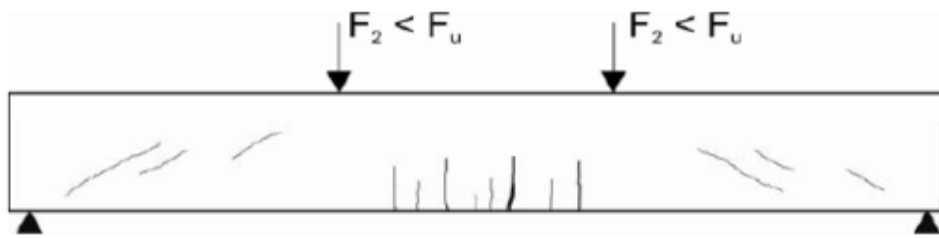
Formação de fissuras inclinadas (fissuras de cisalhamento)
